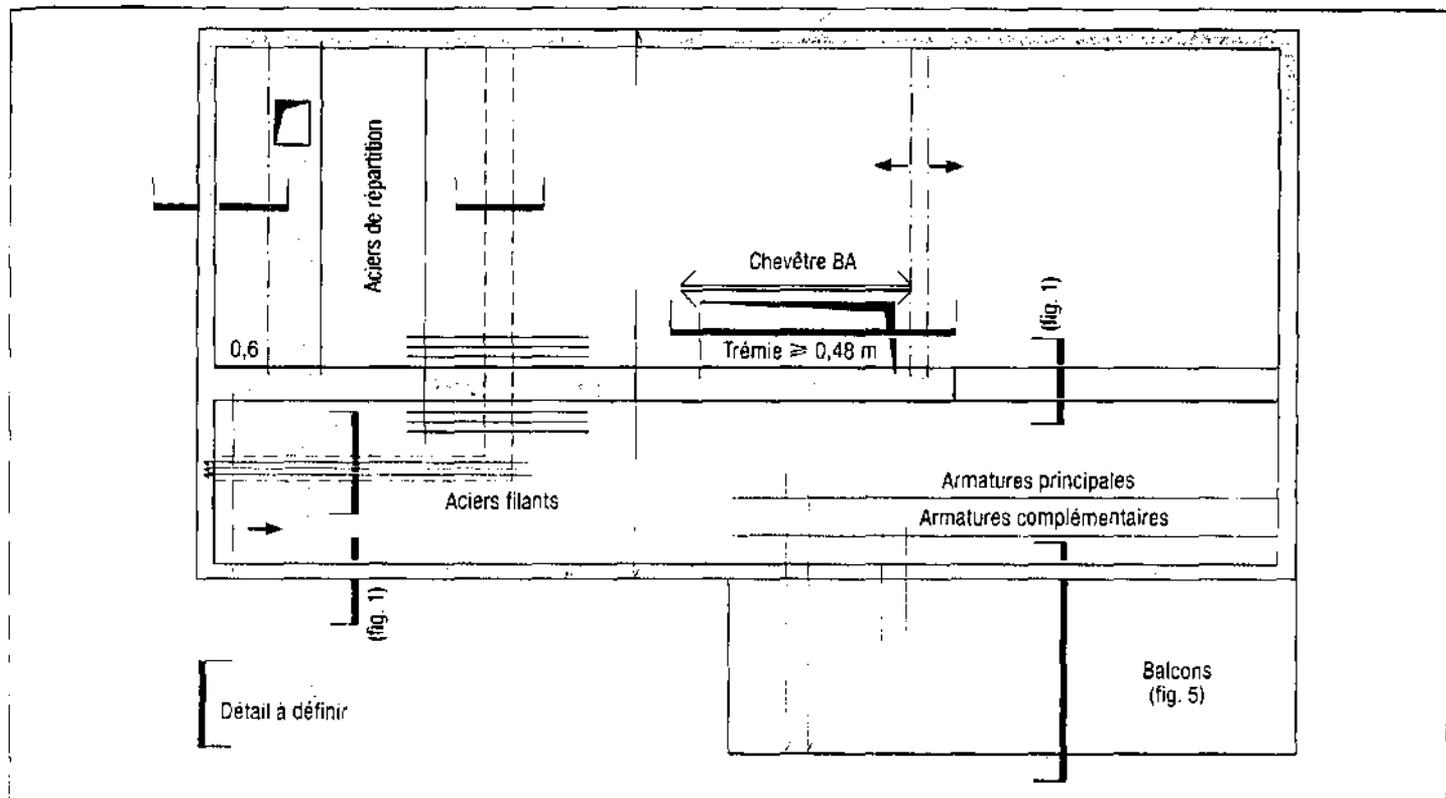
Plan de pose : principe et repérage des détails à définir.
